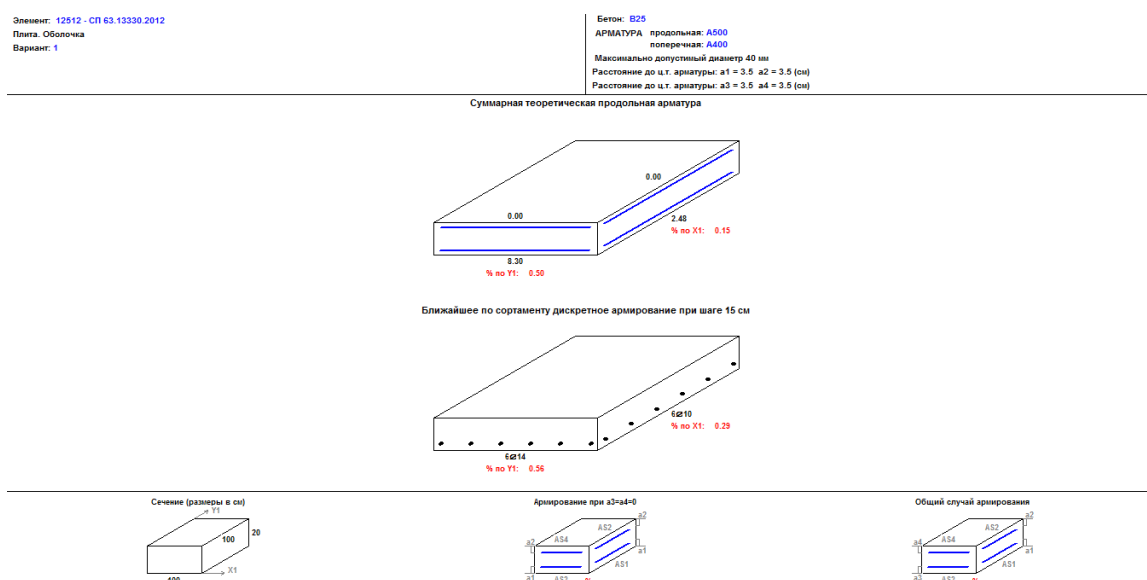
Схема армирования плиты (выполнено в программе SCADOffice)
